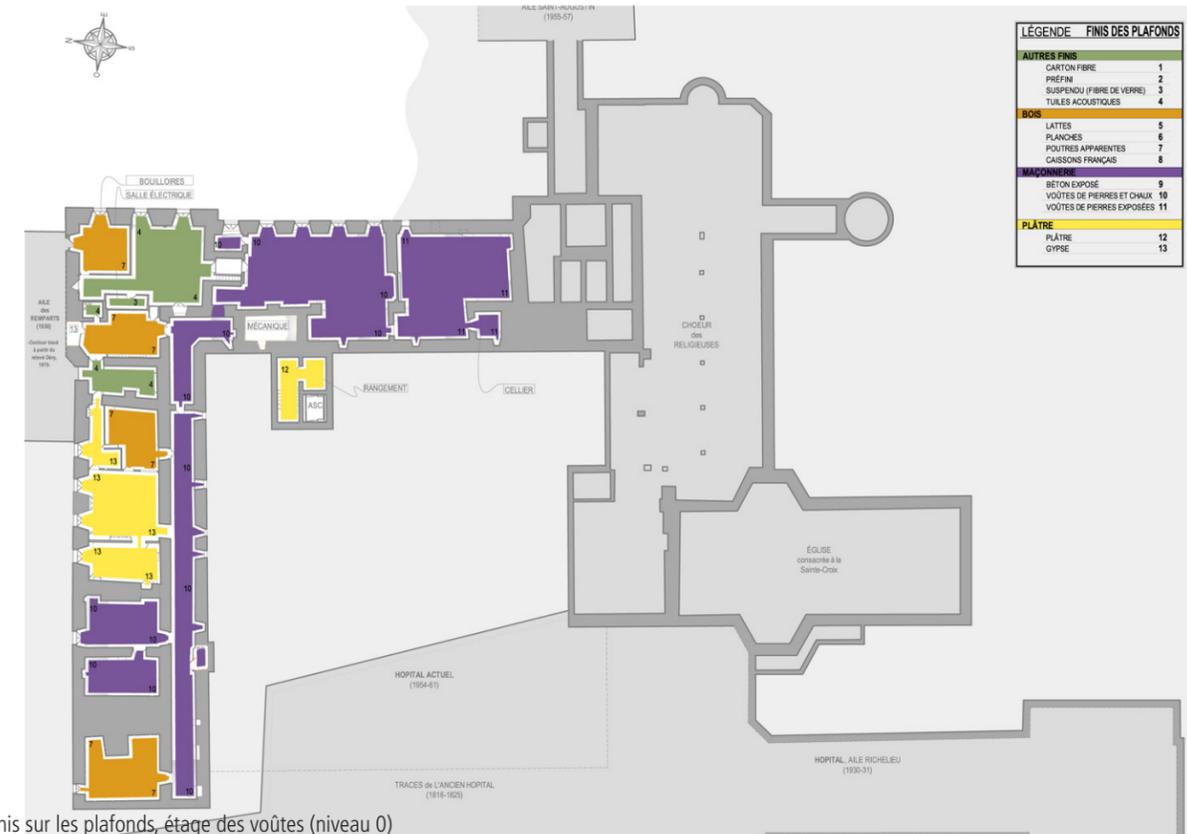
Plan des finis sur les plafonds, étage des voûtes (niveau 0)
